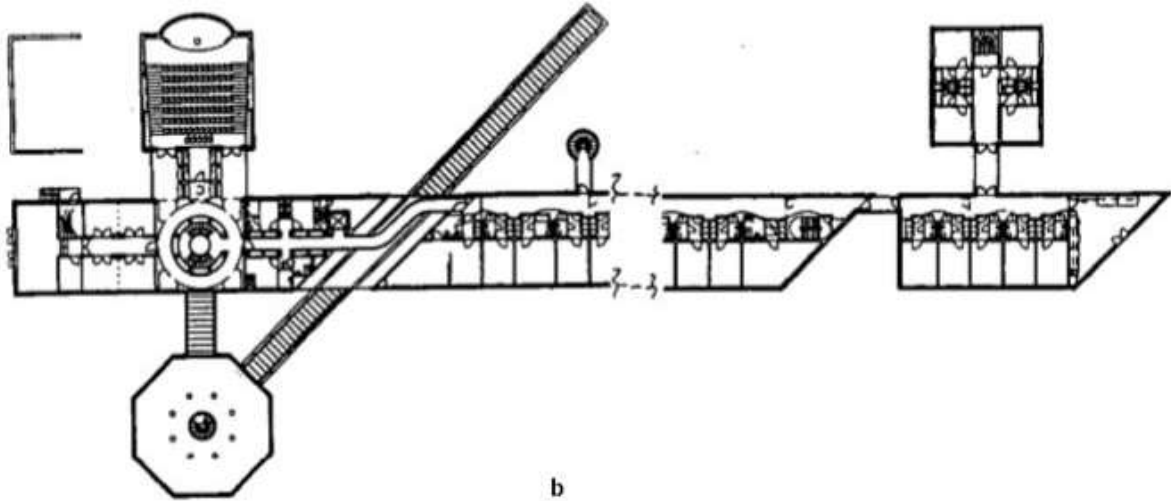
Planta do Pavimento Tipo. The Maersk Mckinney Moller Centre, Churchill College, Reino Unido. Fonte: ADLER, 1999.
